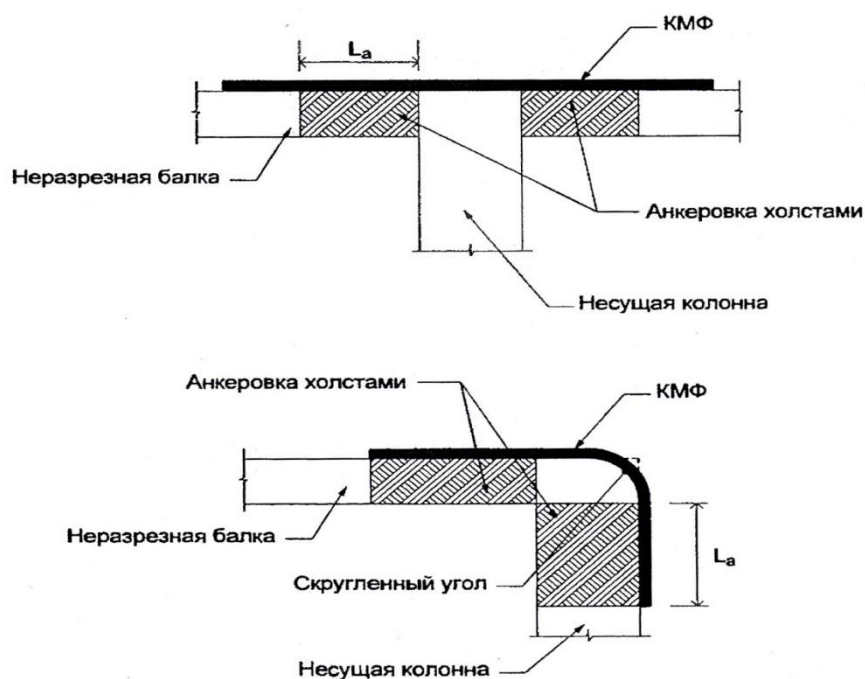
Анкеровка композитных материалов для неразрезных балок на средней и крайней опорах
